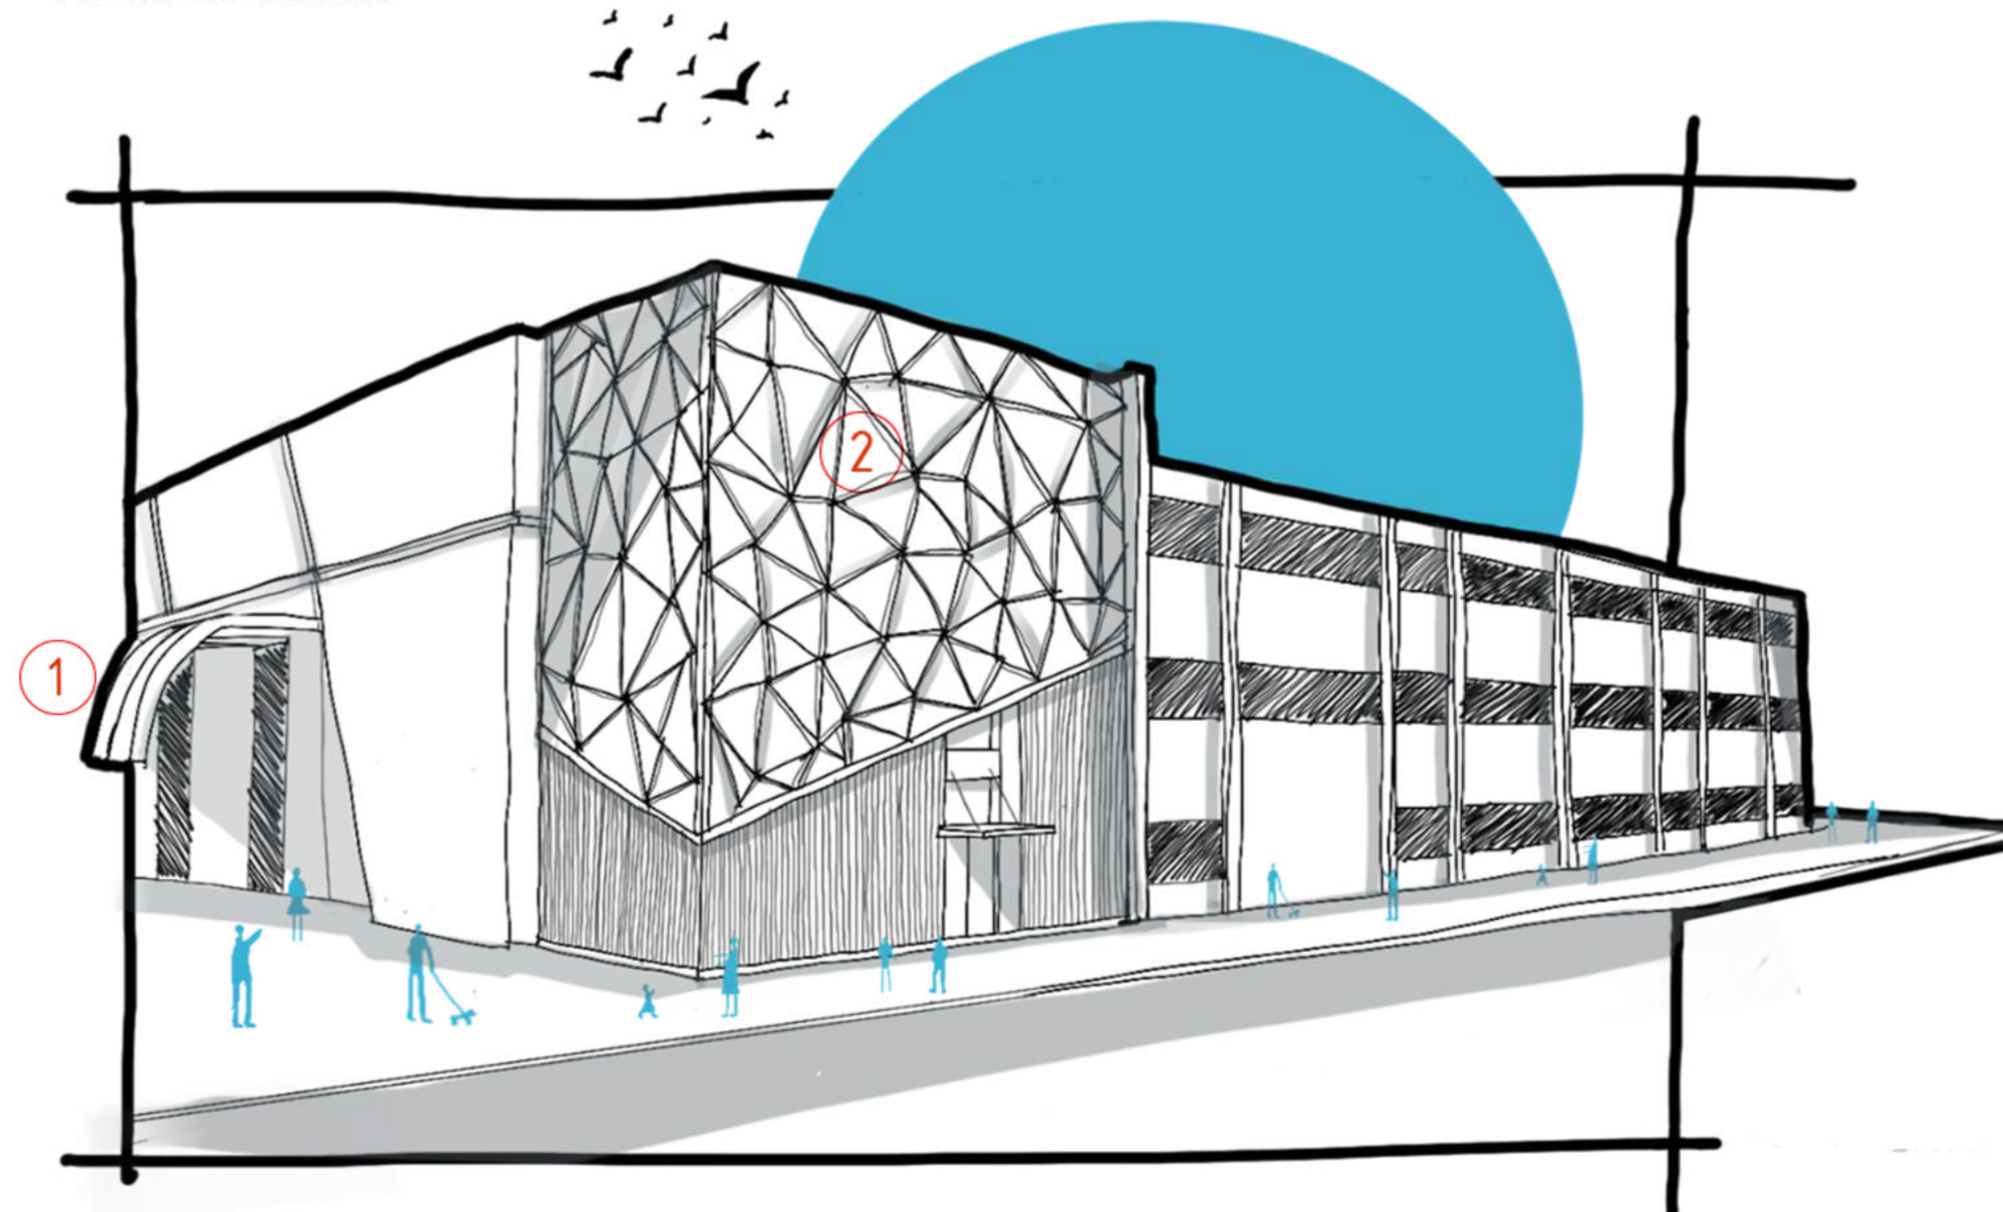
Concepto, Fachada posterior. Elaboración propia.
